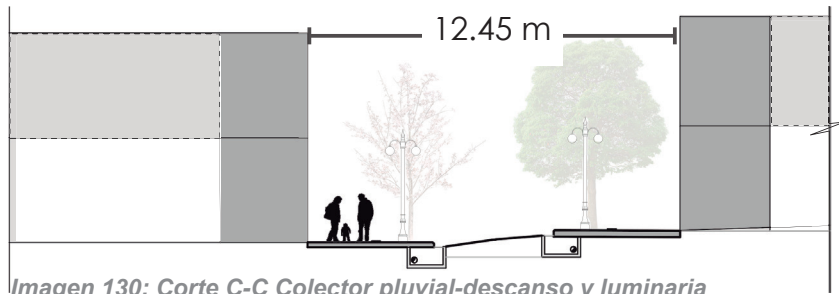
Corte C-C Colector pluvial-descanso y luminaria
